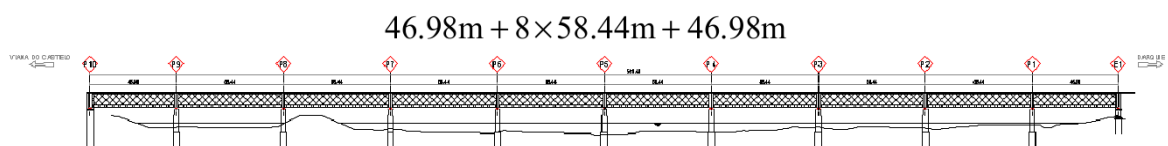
Alçado Longitudinal da Ponte Eiffel [15]
